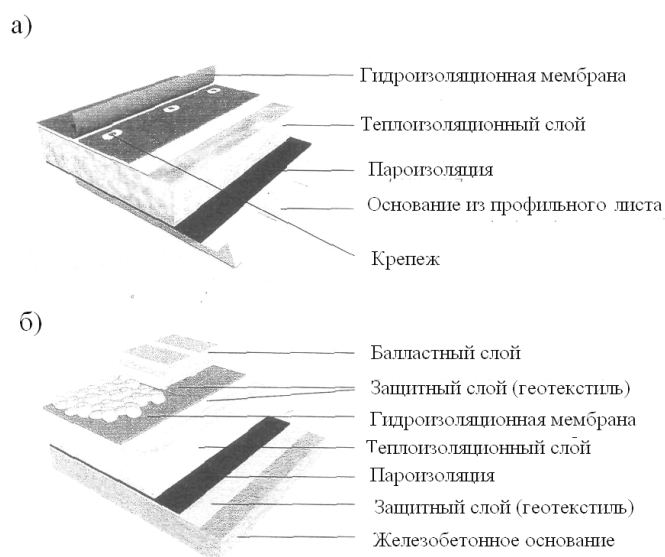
Крепление полимерных гидроизоляционных мембран с механическим (а) или балластным (б) креплением
